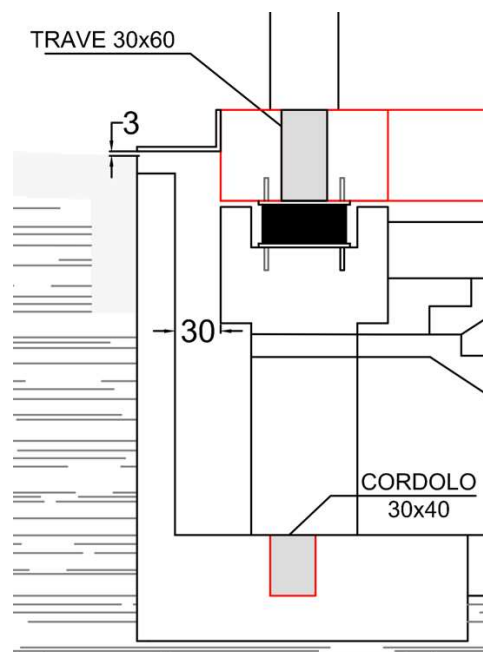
Dettaglio costruttivo: muro di contenimento in c.a. e franco di sicurezza laterale.
